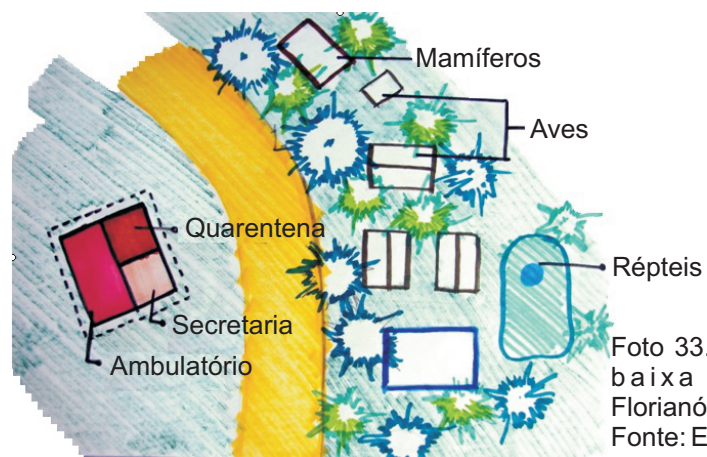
Esquema de planta baixa do CETAS em Florianópolis
